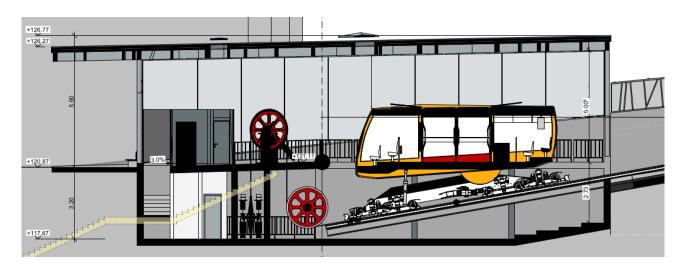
Schnitt geplante Talstation mit ebenerdigem Ein-/Ausstieg
